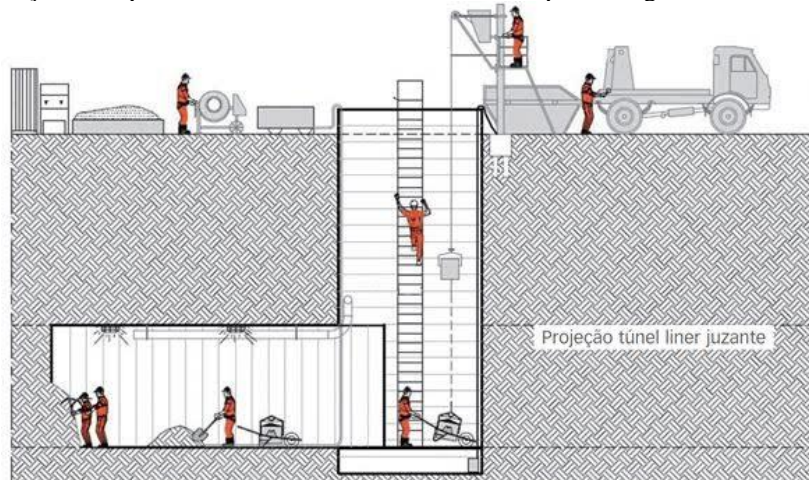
Seção transversal de um *Tunnel Liner* mostrando o revestimento parcial com concreto
